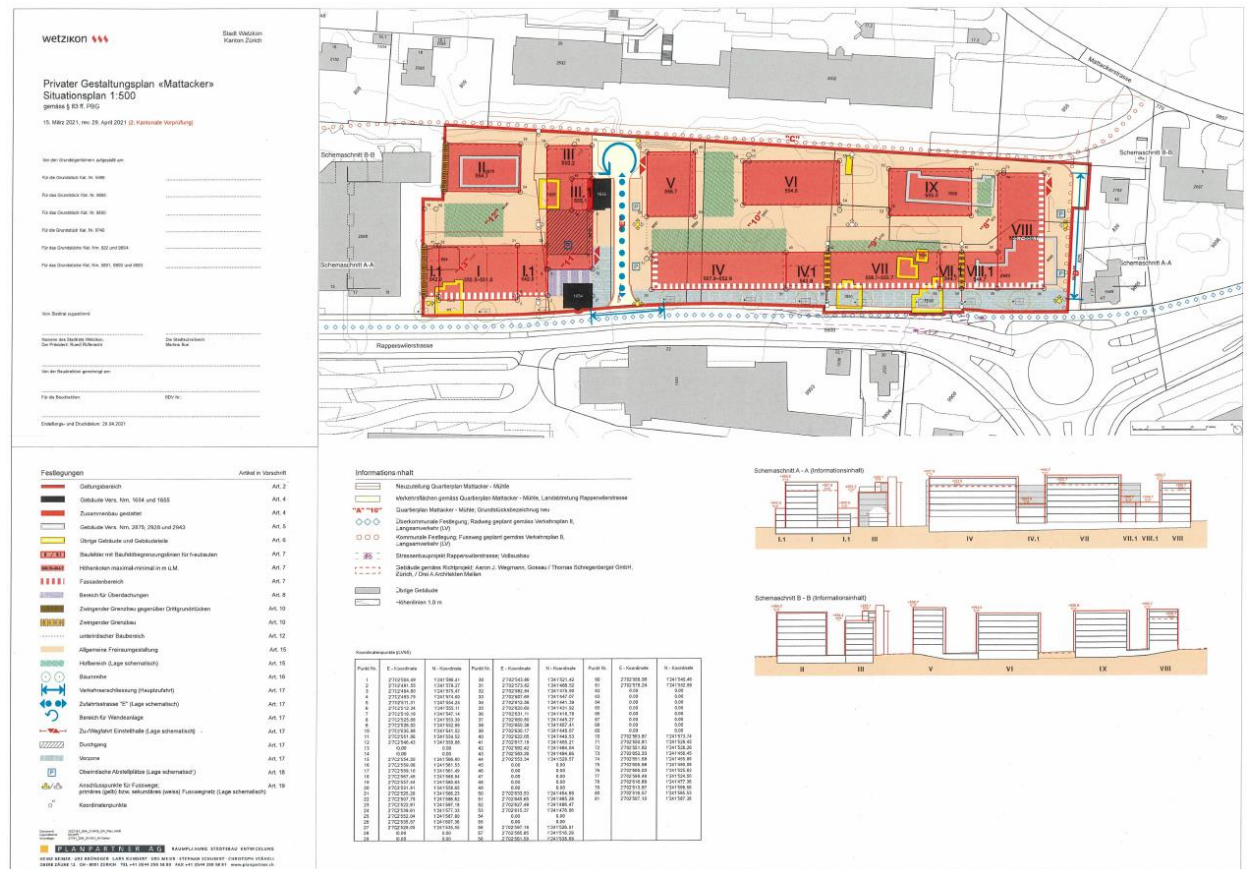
Situationsplan Privater Gestaltungsplan Mattacker (Quelle: Planpartner)
